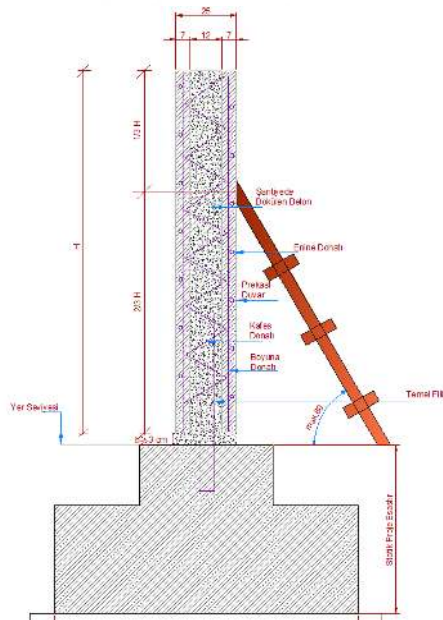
Prefabrik Yay Kesit Elemanı[23]
